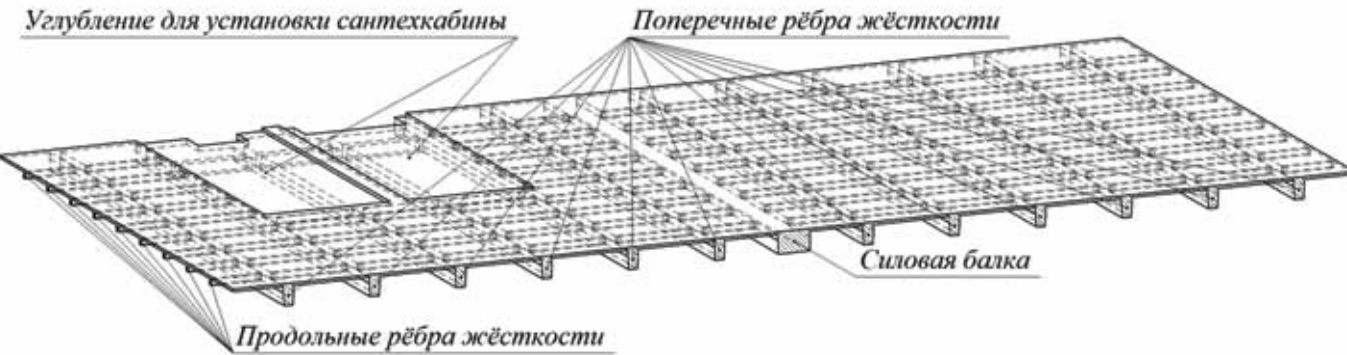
Общий вид интегрированной конструкции перекрытия (пола) без стеновых панелей модуля
